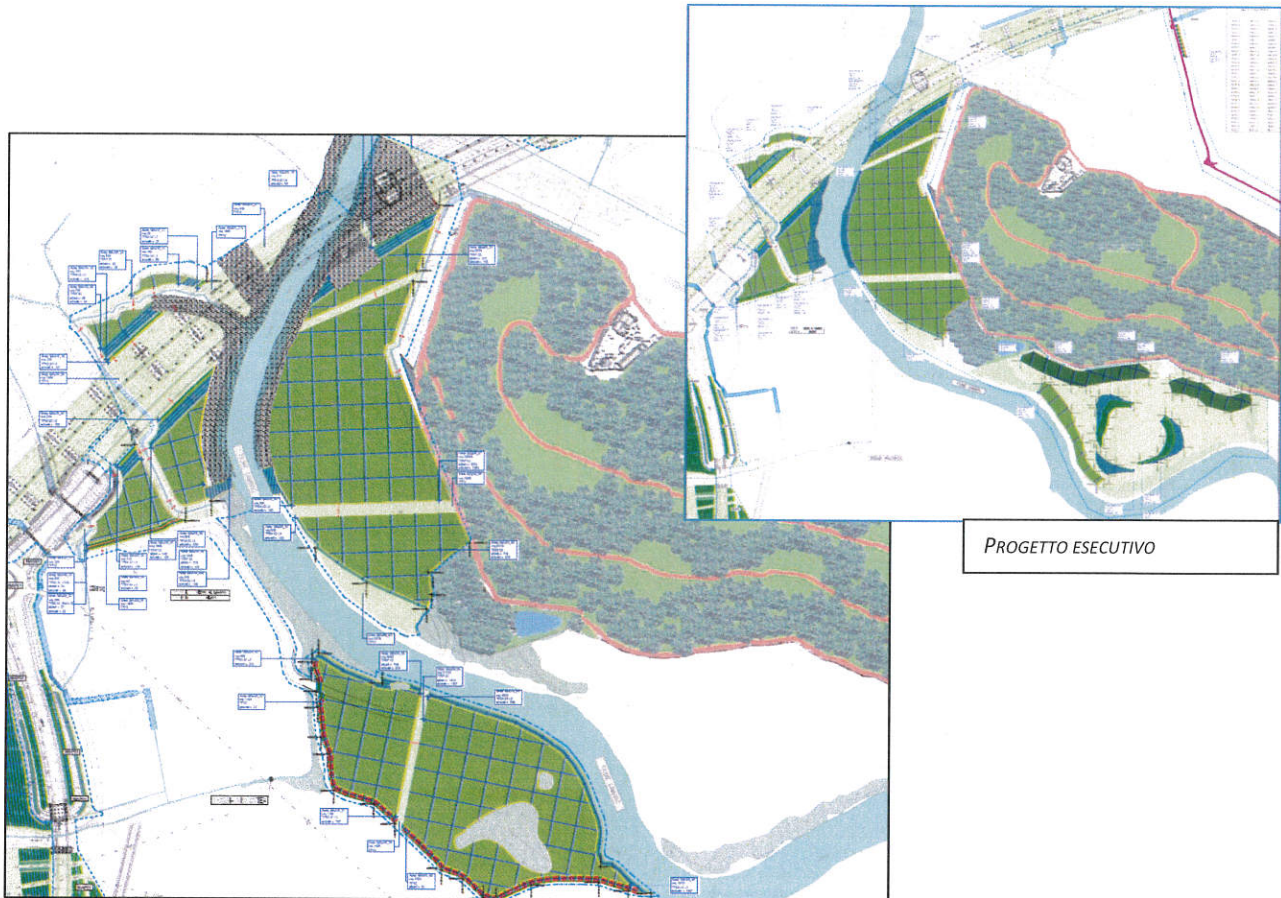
MODIFICA TECNICA- STRALCIO PLANIMETRICO INTERVENTO
